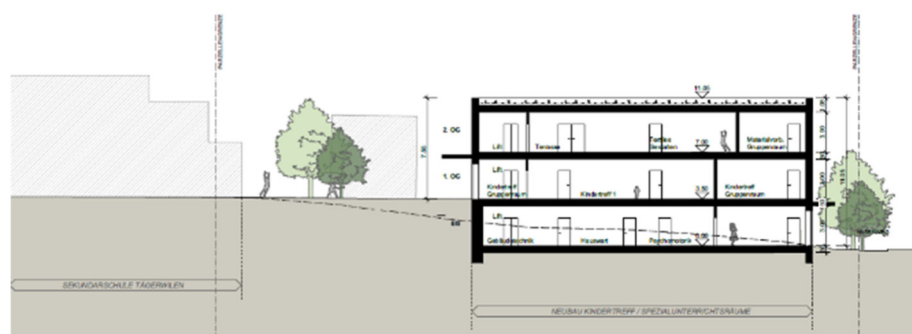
Disposition 04 | Gebäudeschnitt A-A
